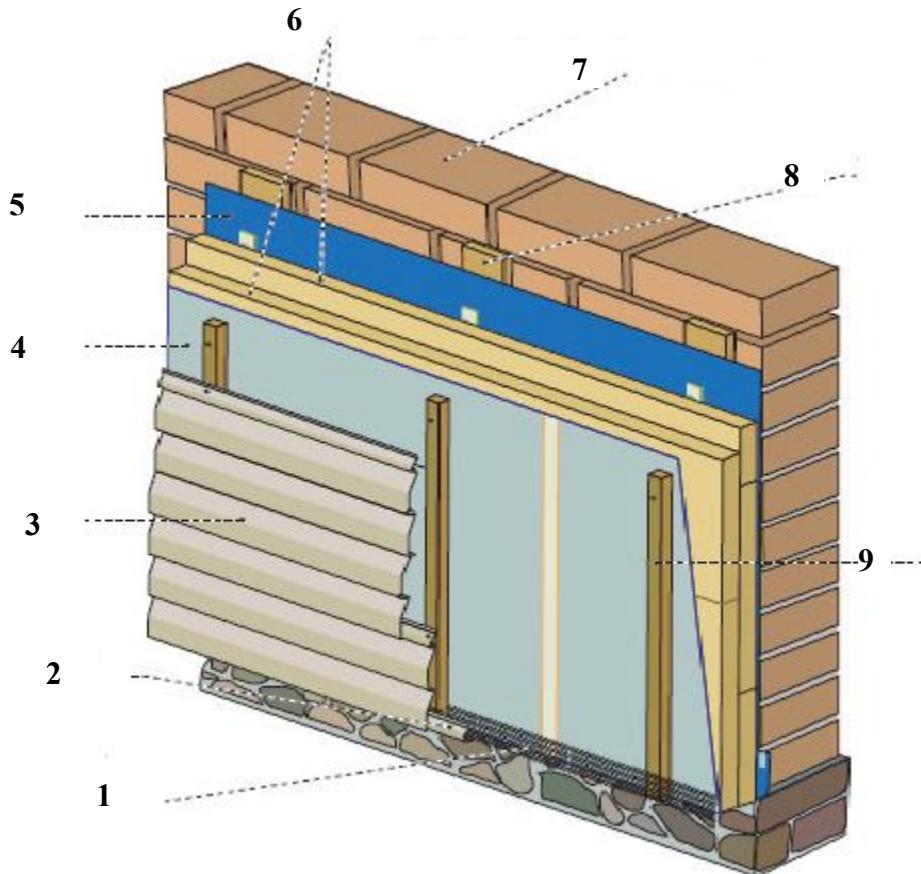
Утеплення фасаду сайдинговою системою: 1 – вентиляційна решітка, захищена сіткою; 2 – стартова планка; 3 – сайдинг; 4 – повітроізоляція; 5 – пароізоляція; 6 – утеплювач (два шара мінеральної вати); 7 – стіна; 8 – дистанційна планка, що забезпечує вентиляцію між стіною та утеплювачем; 9 – дистанційна планка
